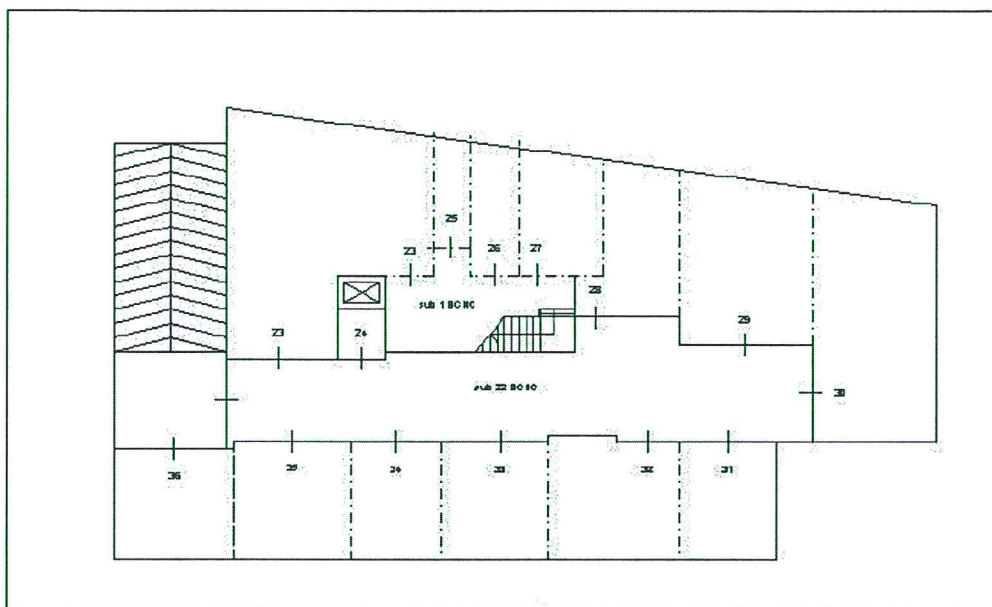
Elaborato planimetrico dei subalterni al piano cantinato del Corpo C
